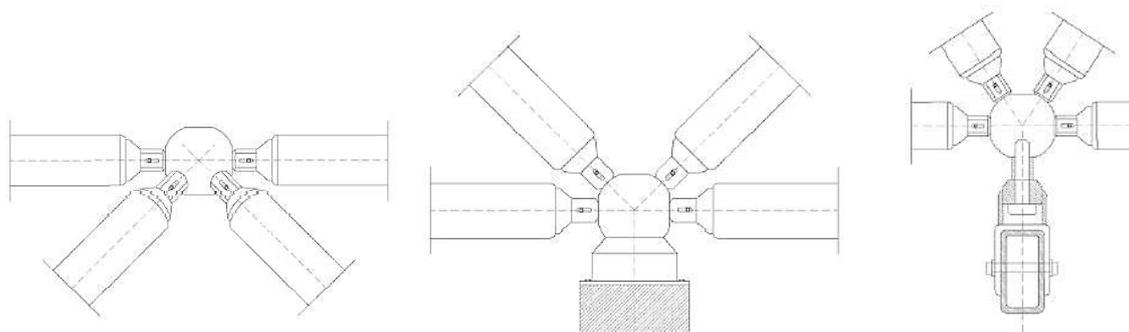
Nudo Mero/Nudo a muro perimetral/Detalle de correa de la subestructura.
